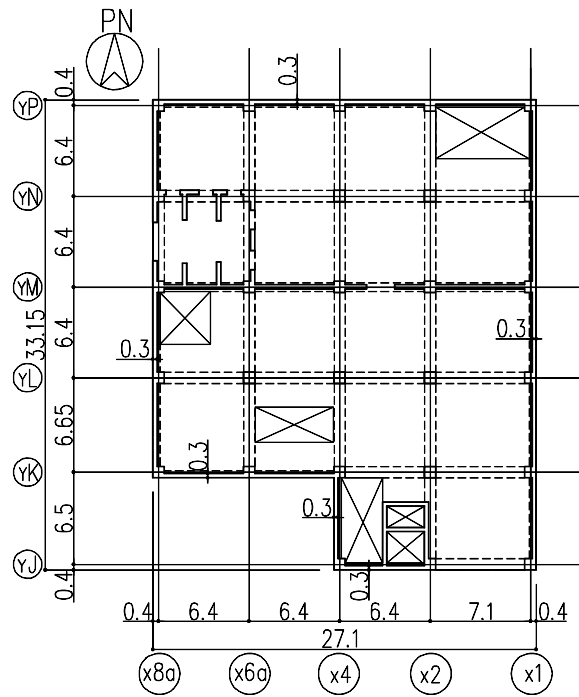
地上2階平面図 (G.L.+4.7) (单位:m)
